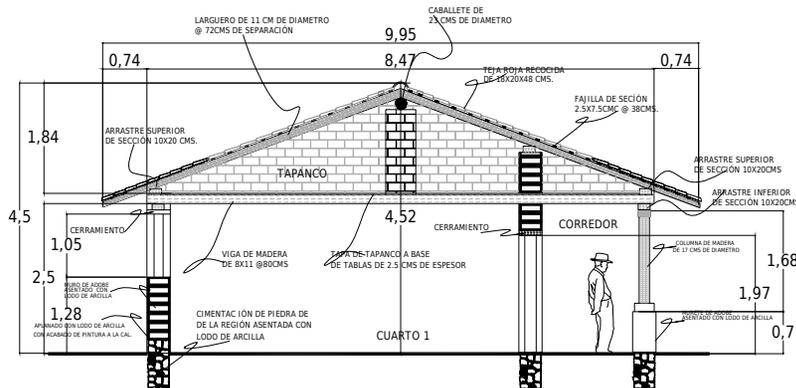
CORTE CONSTRUCTIVO DE LA VIVIENDA TIPO.
